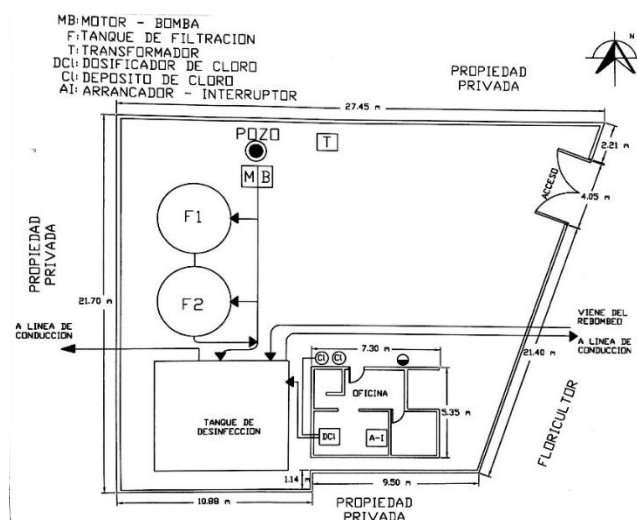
Vista en planta de la PP San Luis Nuevo
